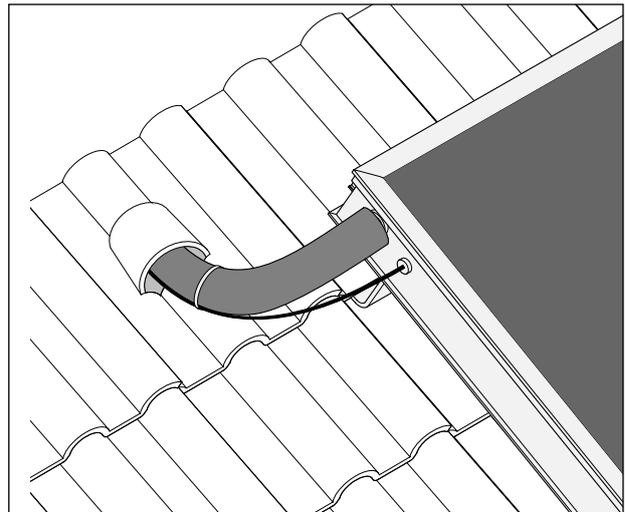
Fühlerkabel mit Kabelbinder an Anschluss Schlauch befestigen.
